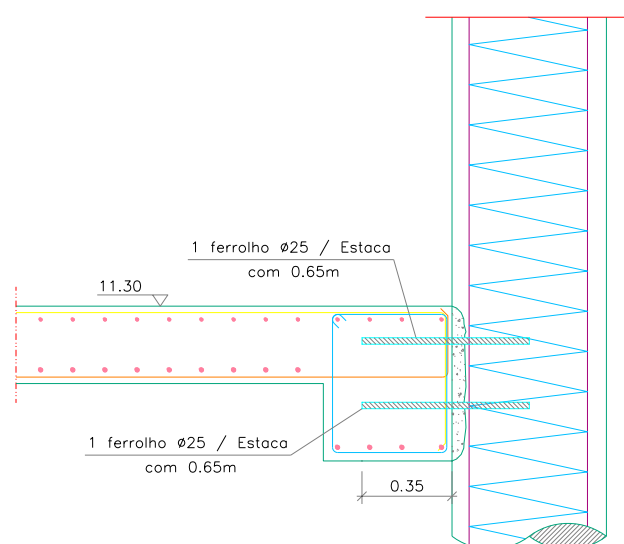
Pormenor de ligação das lajes à cortina de estacas no piso -2.
